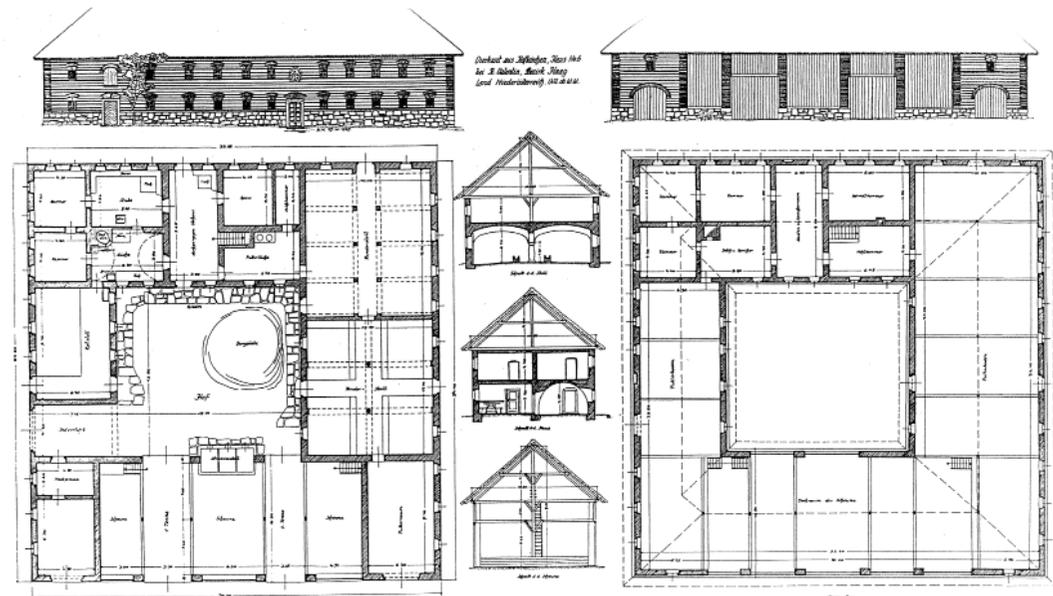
typischer Vierkanthof - Ansicht und Grundriss, A.Klaar
